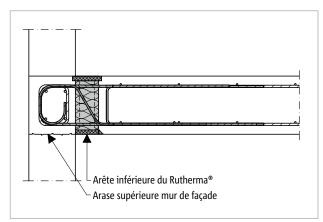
Schöck Rutherma® T type DFi : dalle en béton coulé sur place et façade en béton armé
